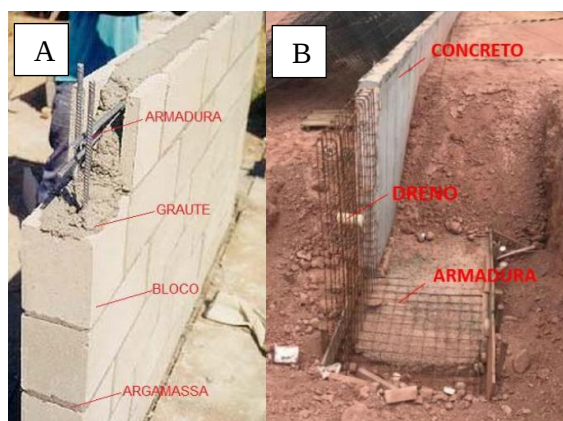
Elementos constituintes da alvenaria estrutural (a) e muro à flexão (b)
